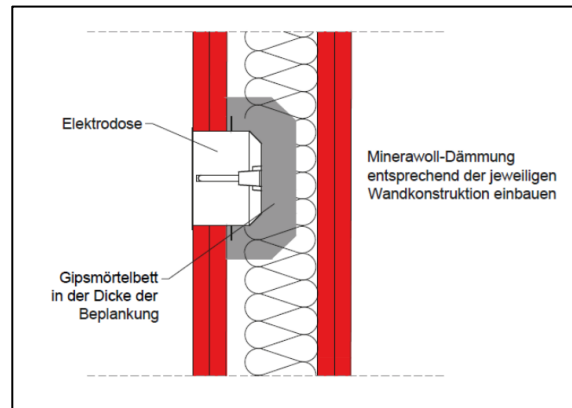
Hohlwanddose in Wandkonstruktion mit Gipsmörtelbett in Beplankungsdicke
